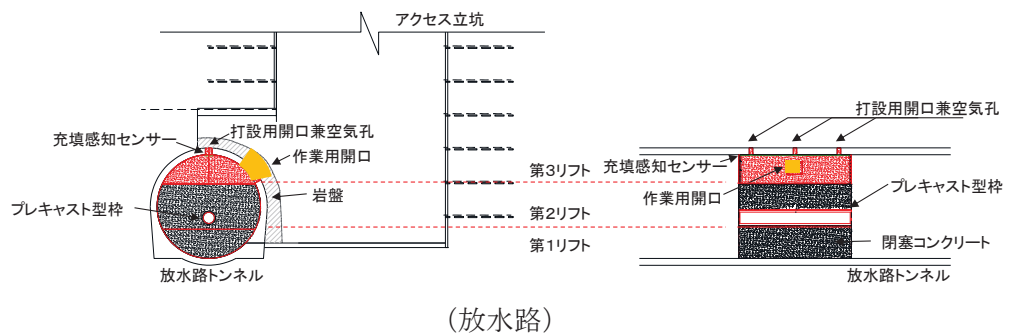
天端付近の充填コンクリートの施工イメージ図
